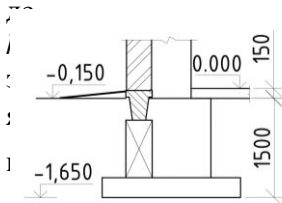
Конструкція фундаменту на перетині осей А і 3.
